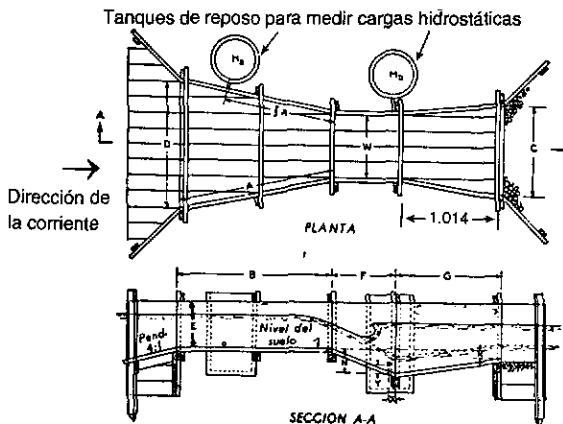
Características y acotaciones de un aforador Parshall, vista planta y corte transversal.
